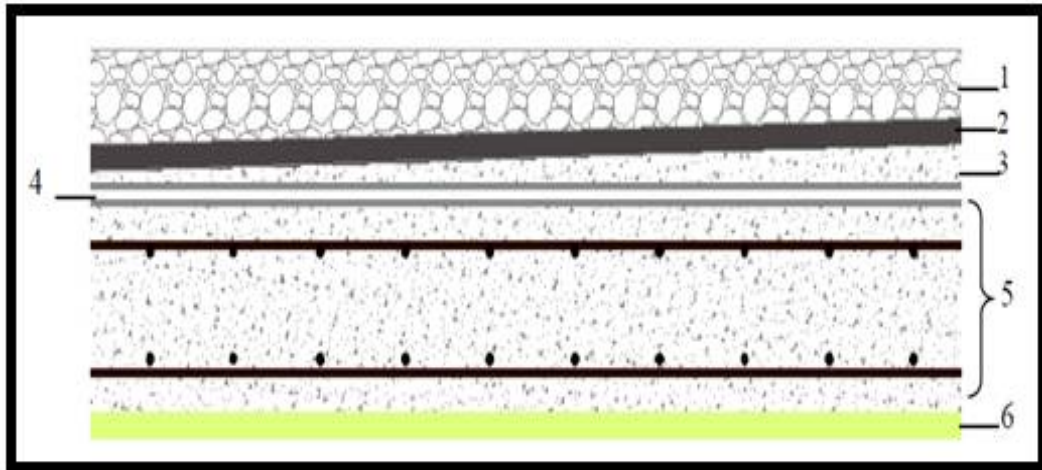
Composants d'un plancher terrasse en dalle pleine.
